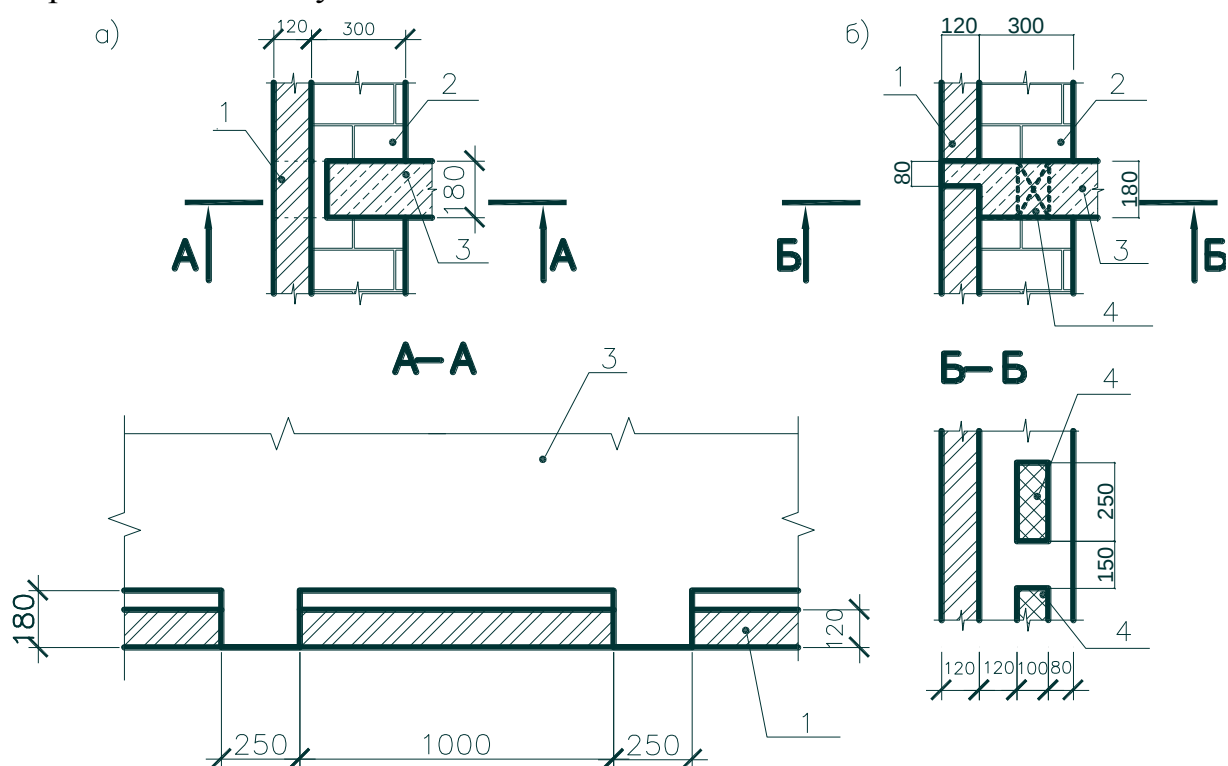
Узлы сопряжения наружных ограждений зданий монолитно-каркасной конструкции с дисками перекрытий.
